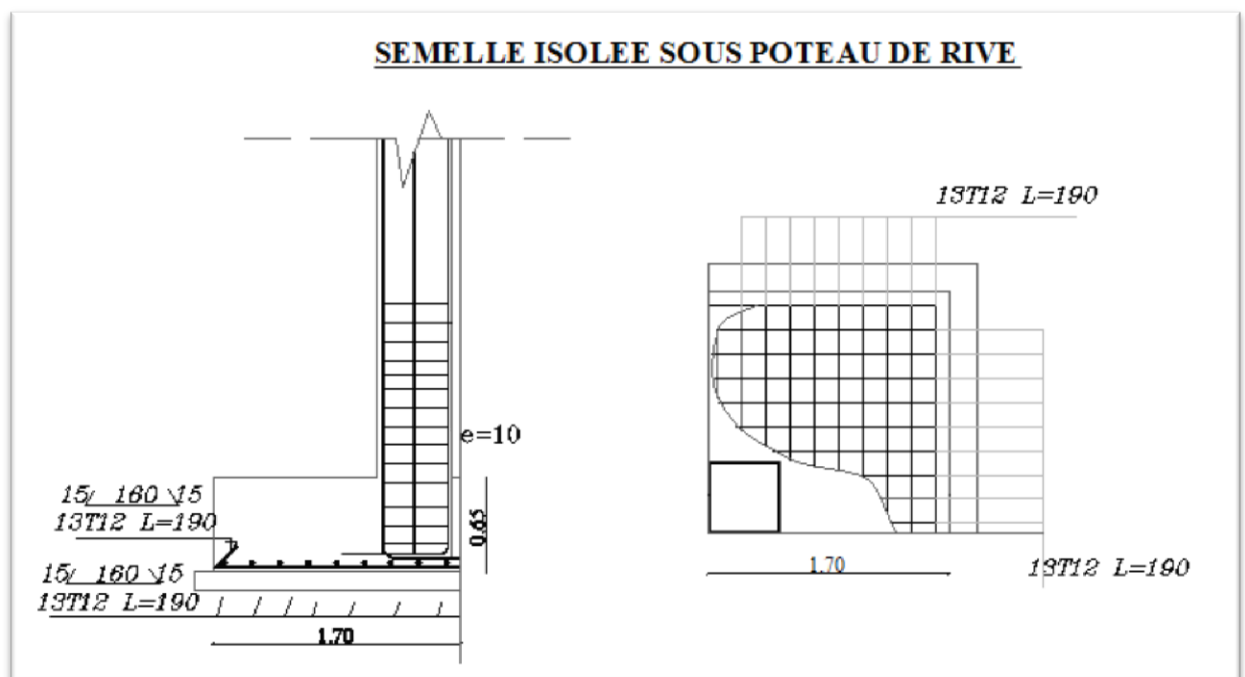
Schéma de ferrailage de semelle isolée de rive (x-x).
